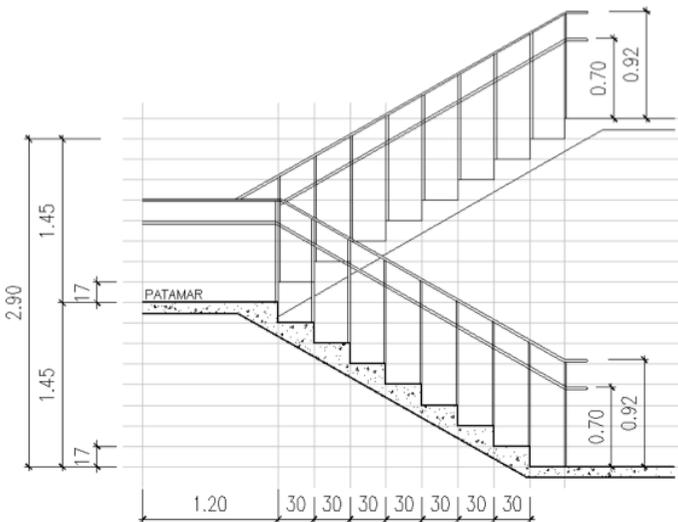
| Exemplo de desenho esquemático do corte da escada
